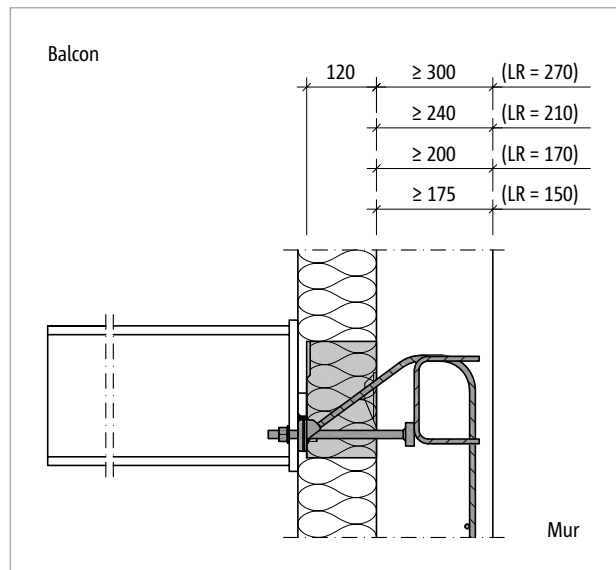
Schöck Isokorb® XT type SQ-WU : construction spéciale pour raccord mural
